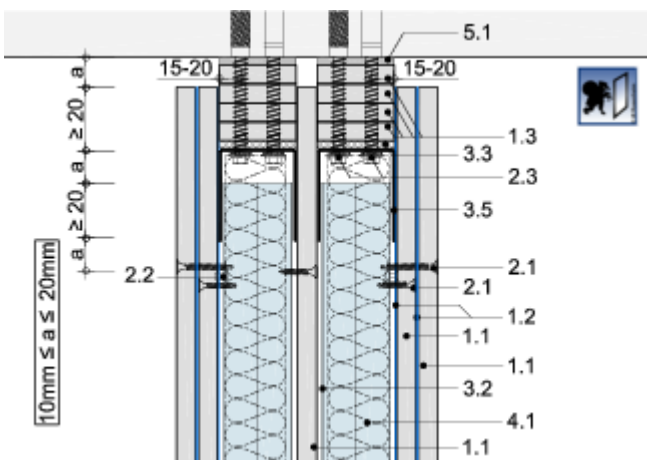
Gleitender Deckenanschluss Einfachständerwand RC 3
